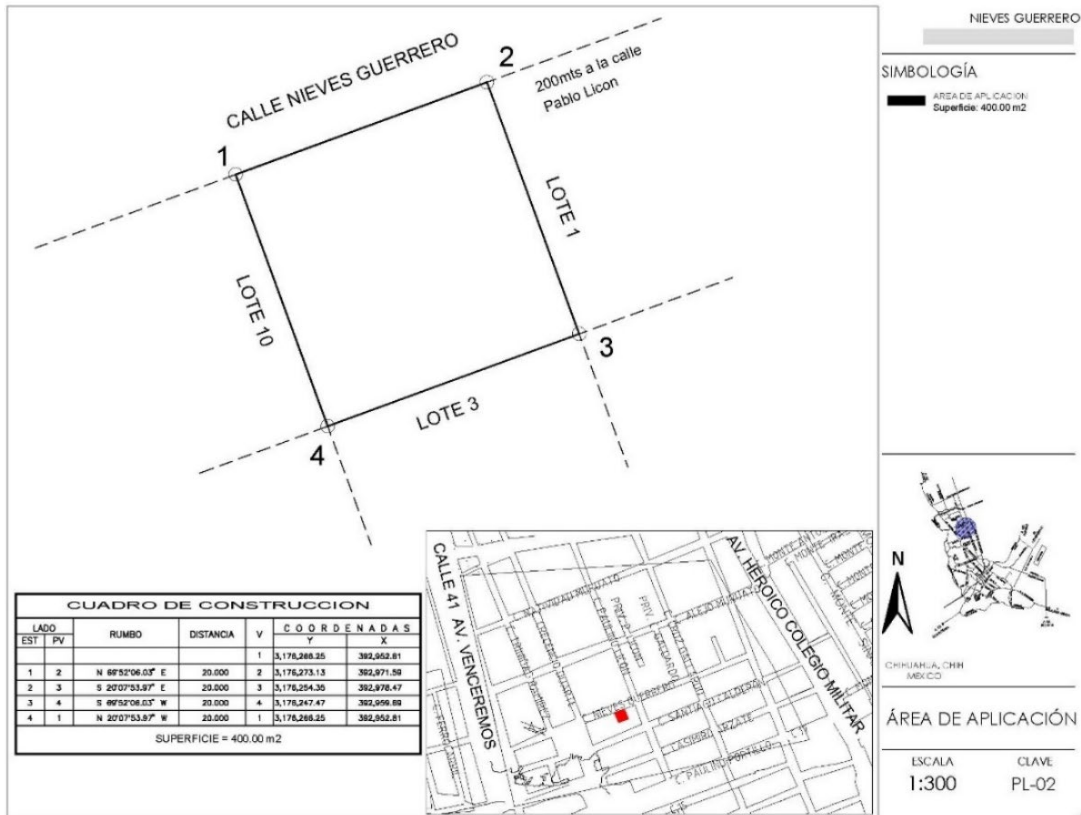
ÁREA DE APLICACIÓN. FUENTE: ELABORACION PROPIA
